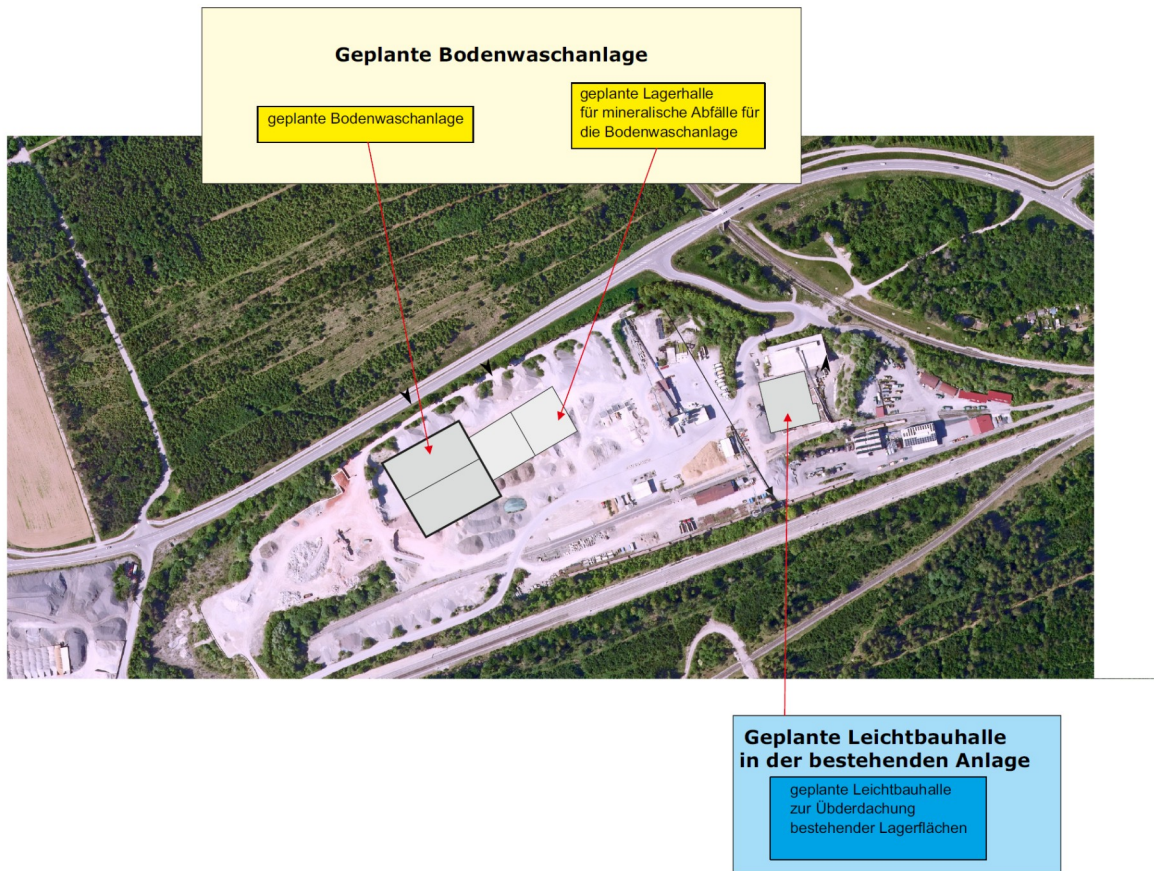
Schematische Darstellung der Lage der geplanten Bodenwaschanlage und der geplanten Leichtbauhalle in der bestehenden Anlage auf dem Betriebsgelände
